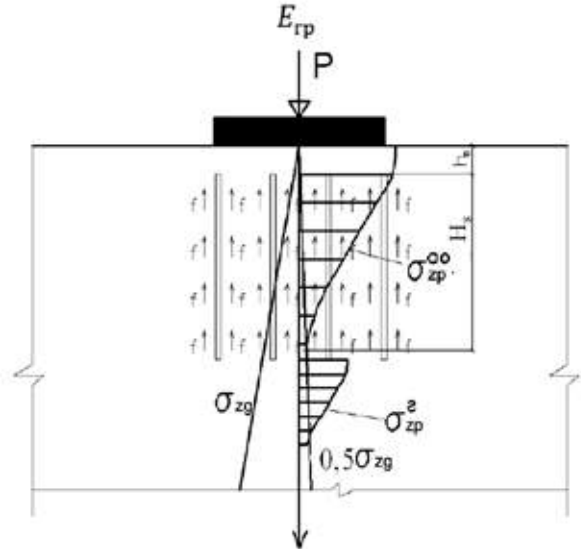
Схема для расчета осадки армированного вертикальными элементами грунтового основания
